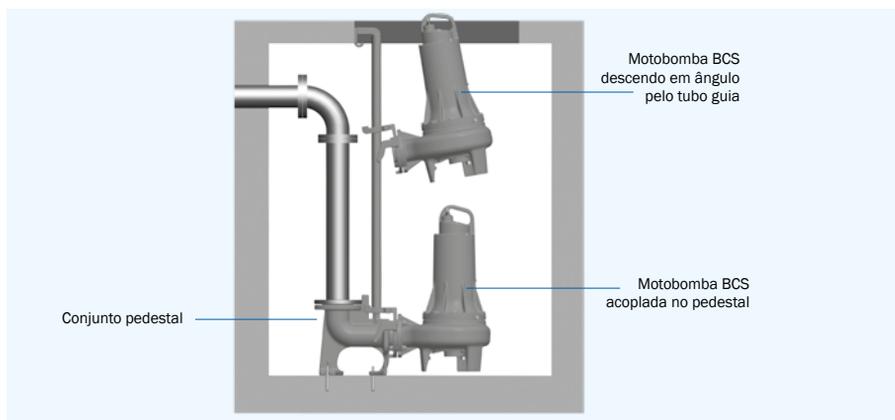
Esquema de instalação da motobomba com sistema de acoplamento direto no pedestal.
